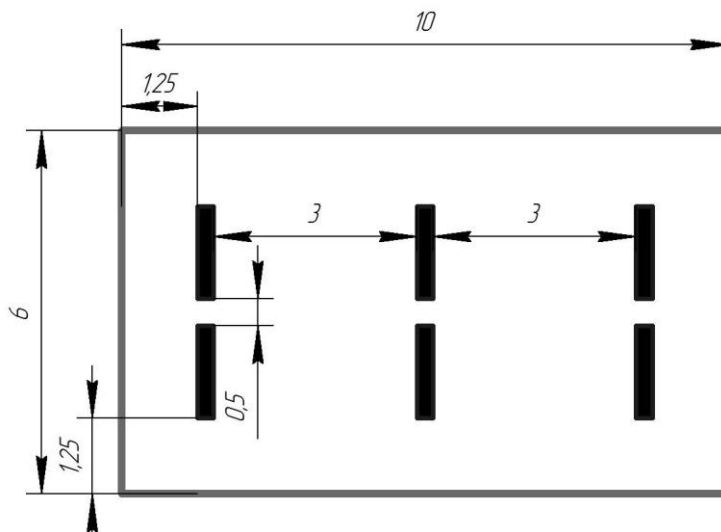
План помещения и размещения светильников с люминесцентными лампами
